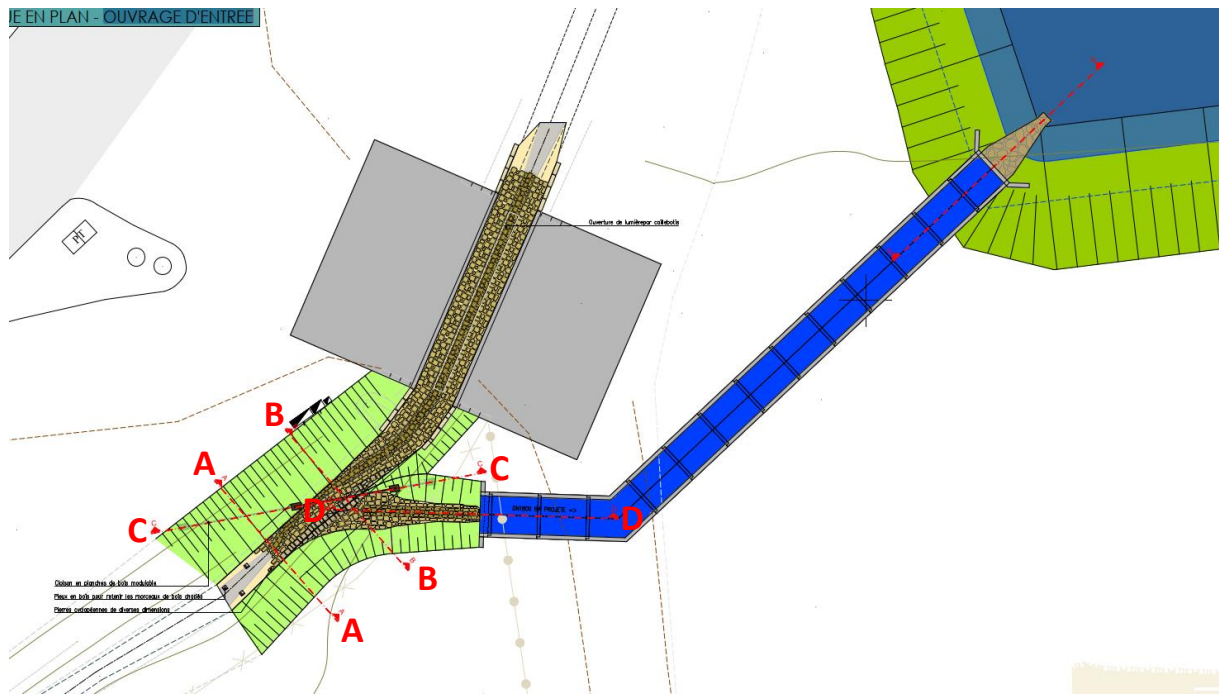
Auszug aus dem veralteten Plan „Concept d'assainissement - Vues en plan et coupes ouvrages“ (Quelle: Luxplan S.A. Stand 06/2020): Draufsicht des geplanten gravitären Beckenzulaufs vom westlichen Klausbach-Zufluss aus; die Ableitung war unterhalb der Brücke vorgesehen.
